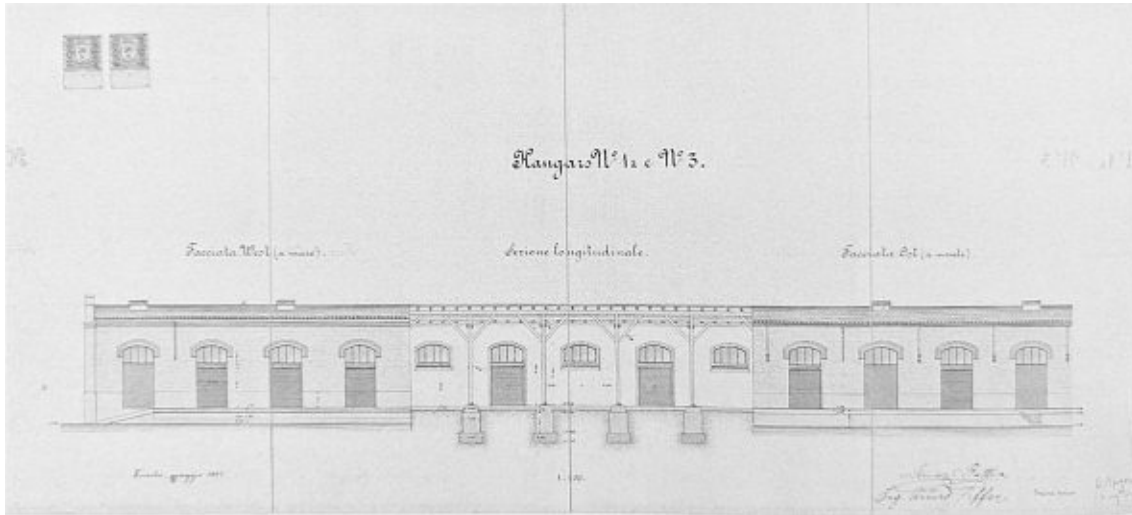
Lagerhaus 1a und 3, Fassadenschnitt
